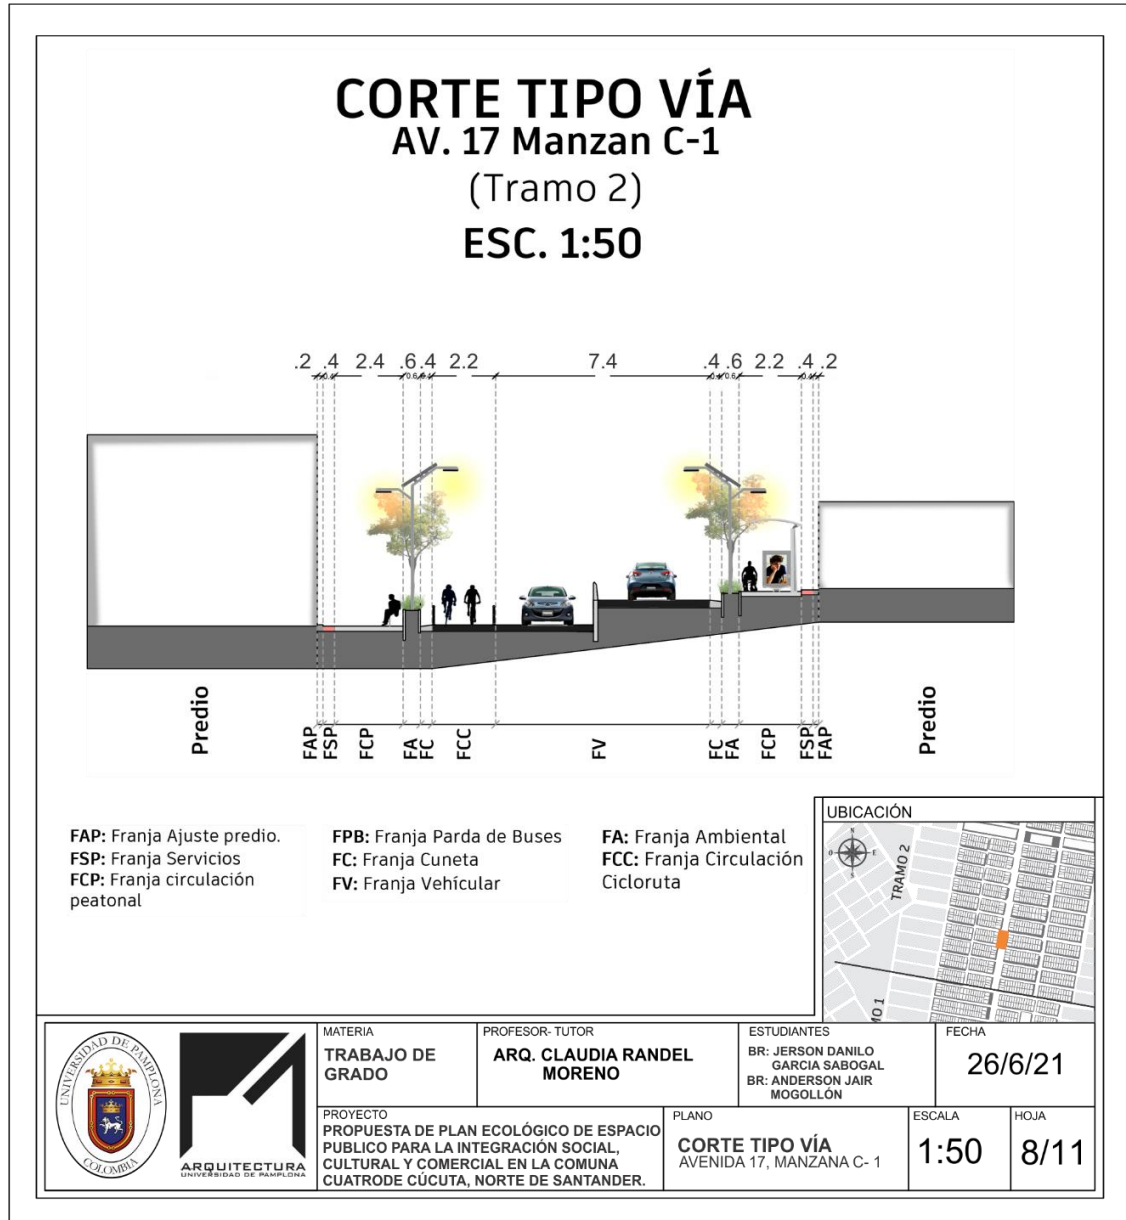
planimetría corte proyecto Av 17 Mz.
